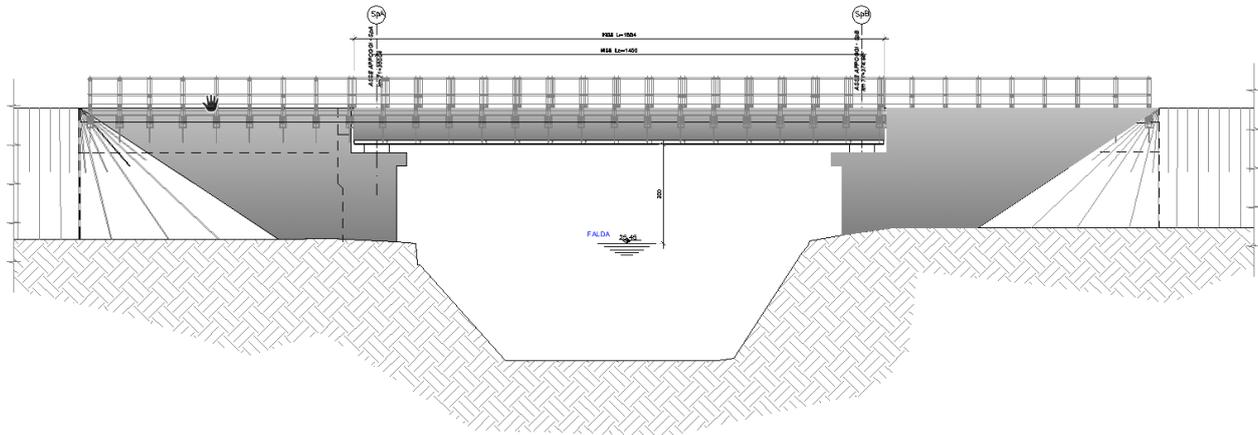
VI03 VI01: Prospetto longitudinale (NM2503D26PBVI030002A)
